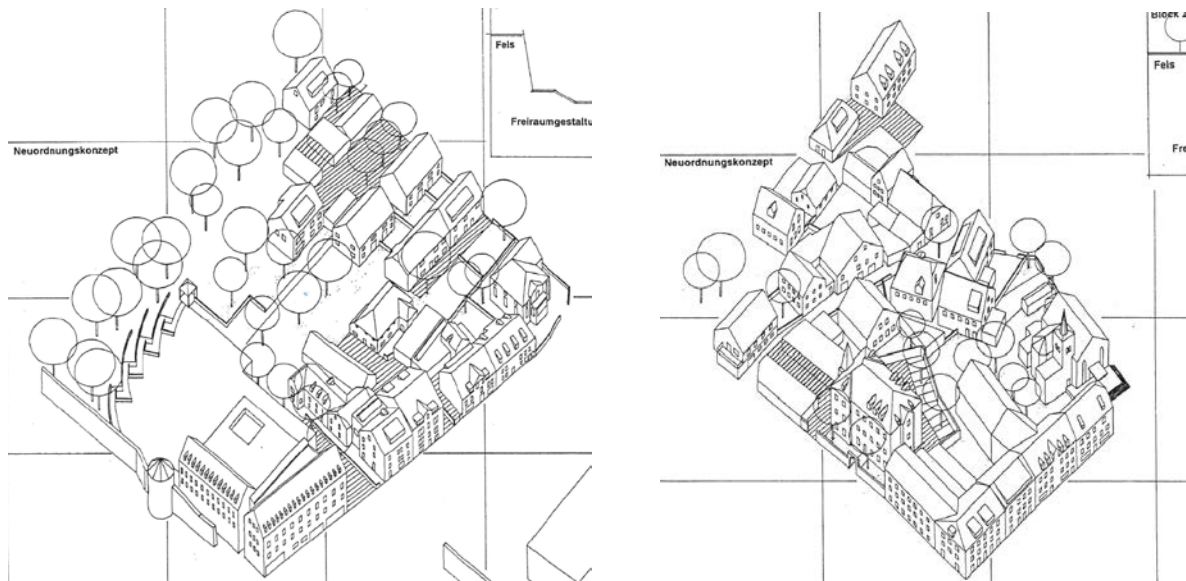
und 10: Städtebauliche Rahmenplanung Sanierungsgebiet Altstadt II West Überlingen (1998): Block Gartenstraße (links) und Grabenstraße (rechts)
